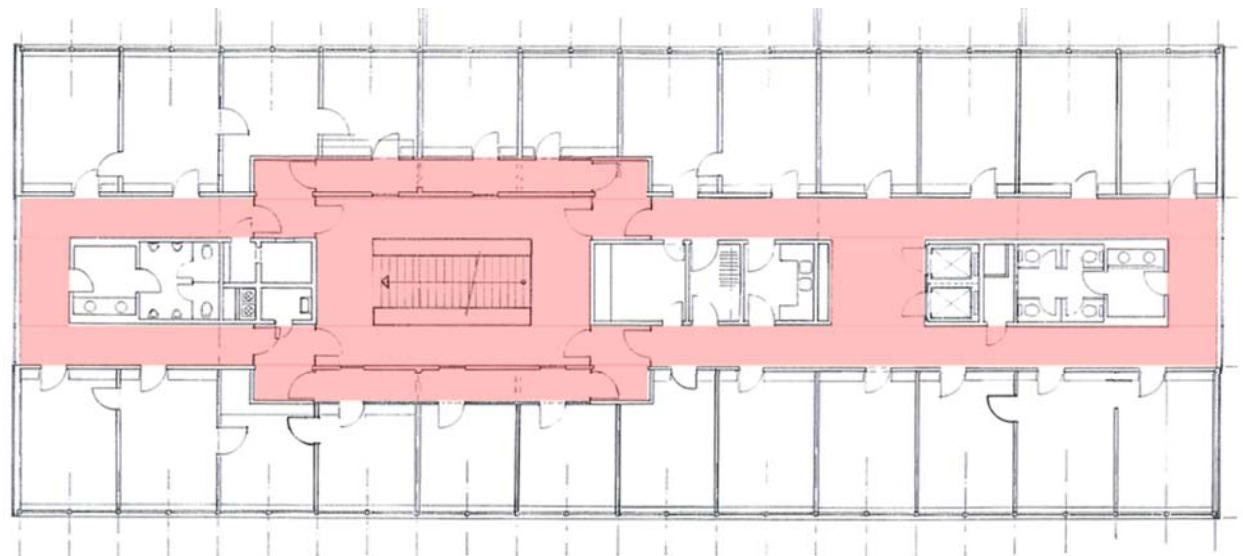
Grundriss Regelgeschoss 2.OG
